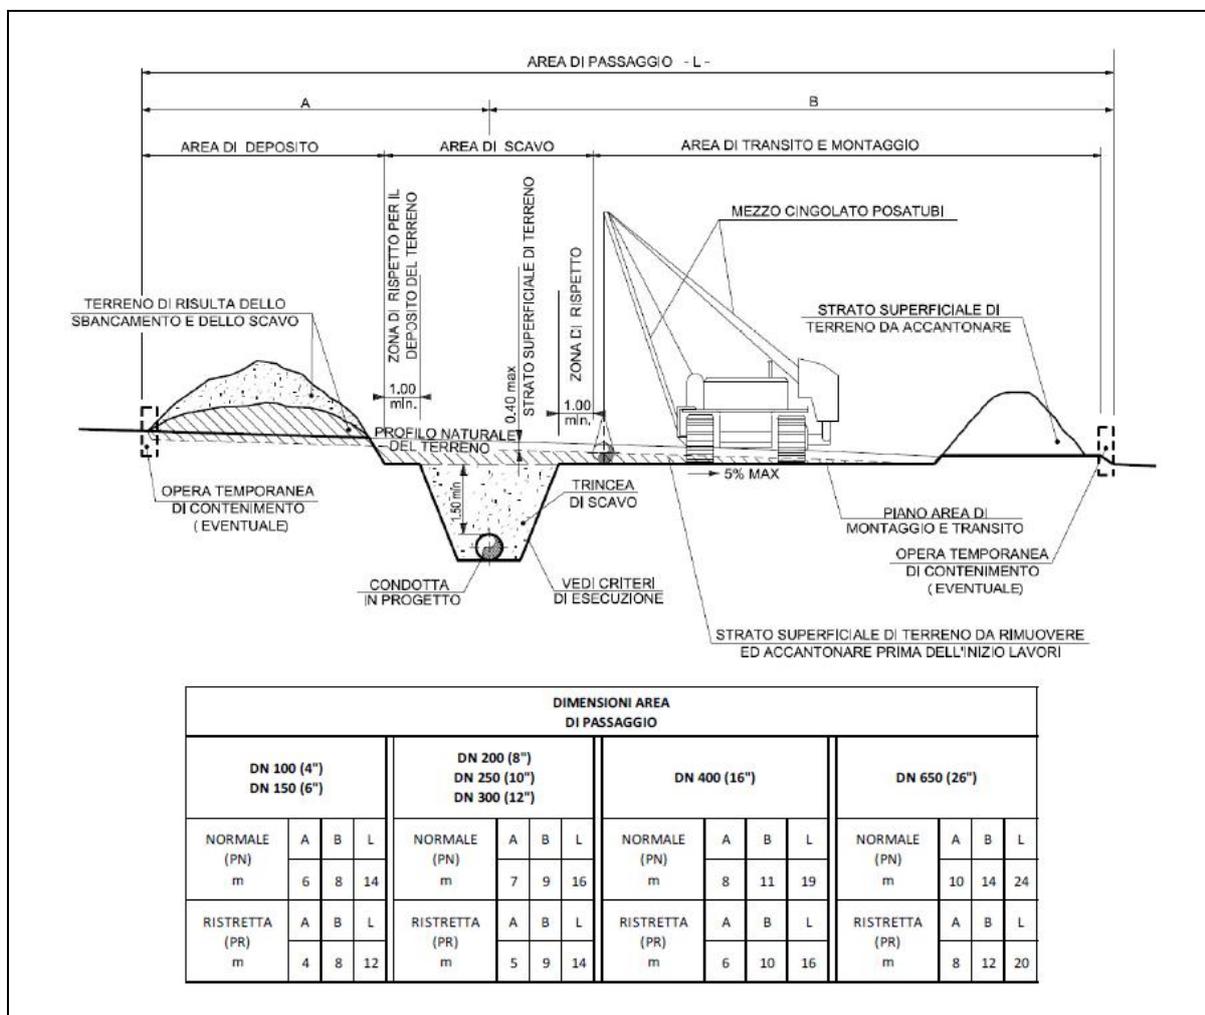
Sezione tipica dell'area di passaggio per posa condotta – costruzione
